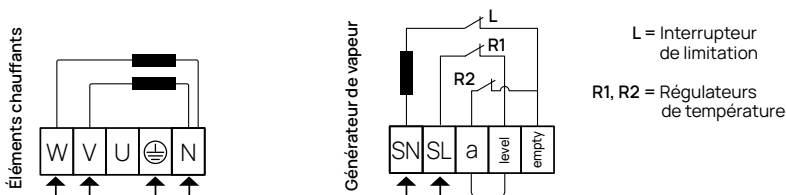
Raccordements CORE Wall Mini et CORE Wall Mini Combi.
